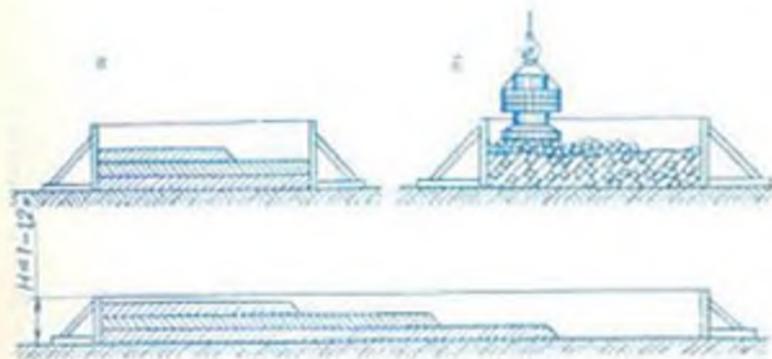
Бетонные работы. Укладка и уплотнение бетонной смеси в блоках бетонирования: а — послойная укладка; б — полурасходная укладка с вибрированием крупного заполнителя в раствор тяжелым вибратором; в — ступенчатая укладка при бетонировании длинными блоками небольшой высоты.
